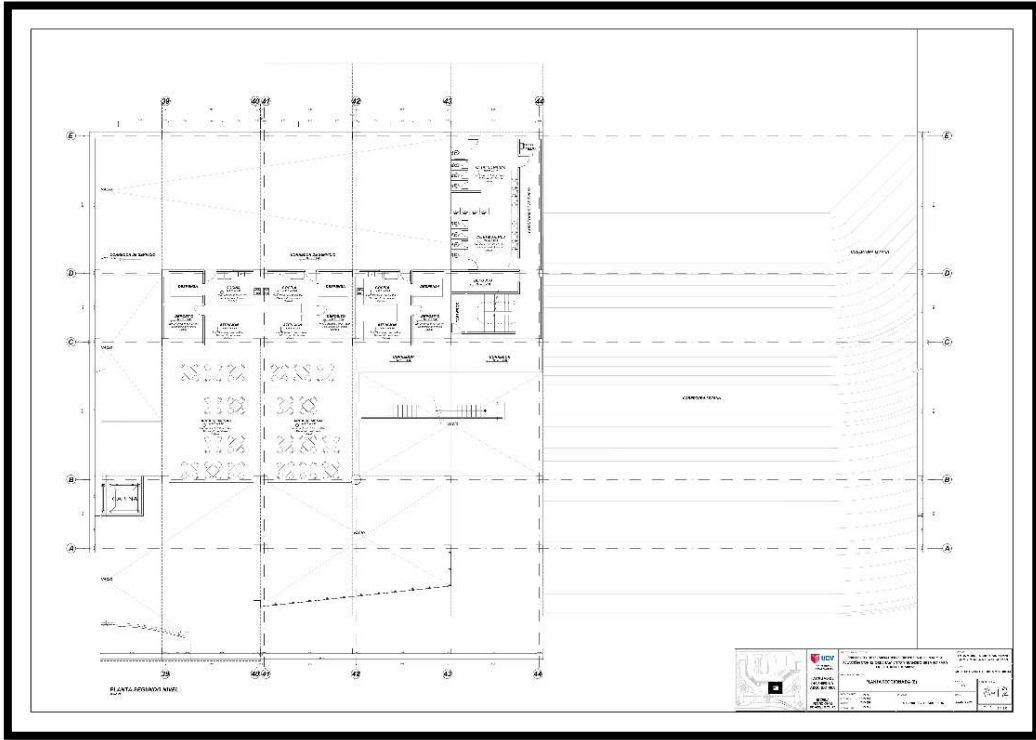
Plano Planta sector (E) Segundo Nivel Fuente: Elaboración Propia.
